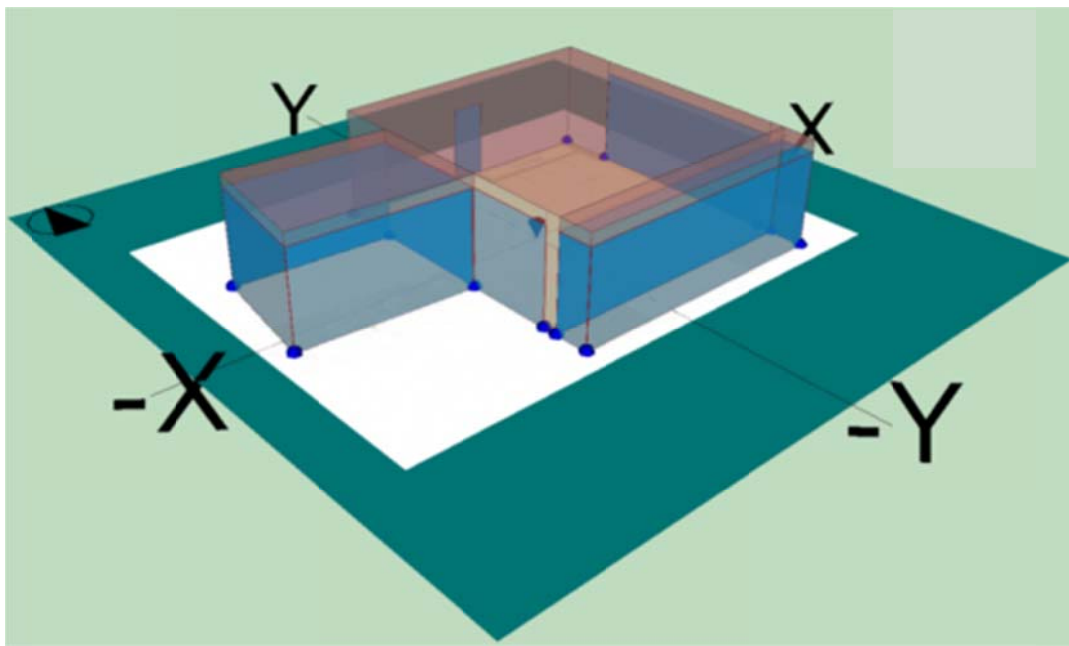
Geometría LIDER primera propuesta VIA-UJI
